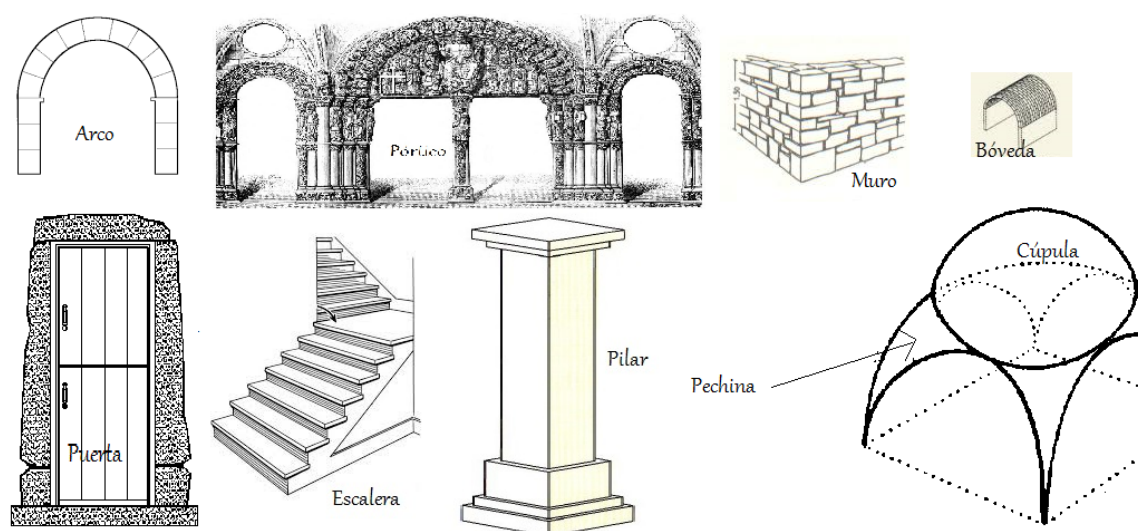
Estructuras básicas arquitectónicas. Elementos arquitectónicos, 2015, EspañolConArte.com
